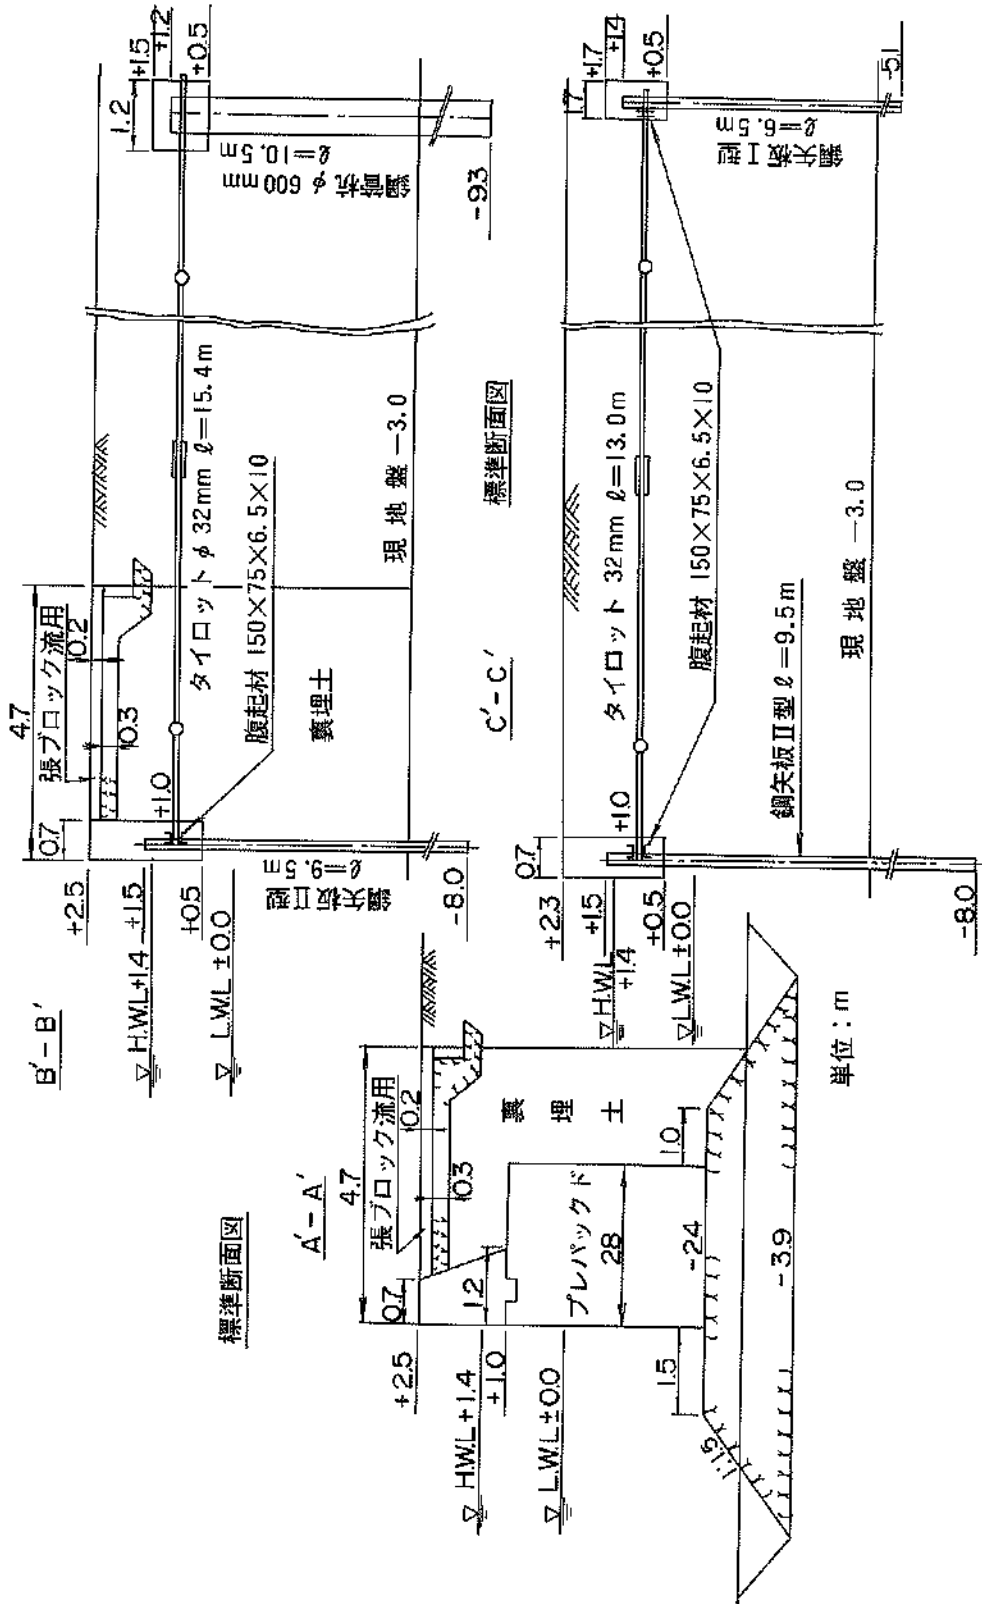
平面図・縦断面図 (㊸中央埠頭岸壁取付先端部)
